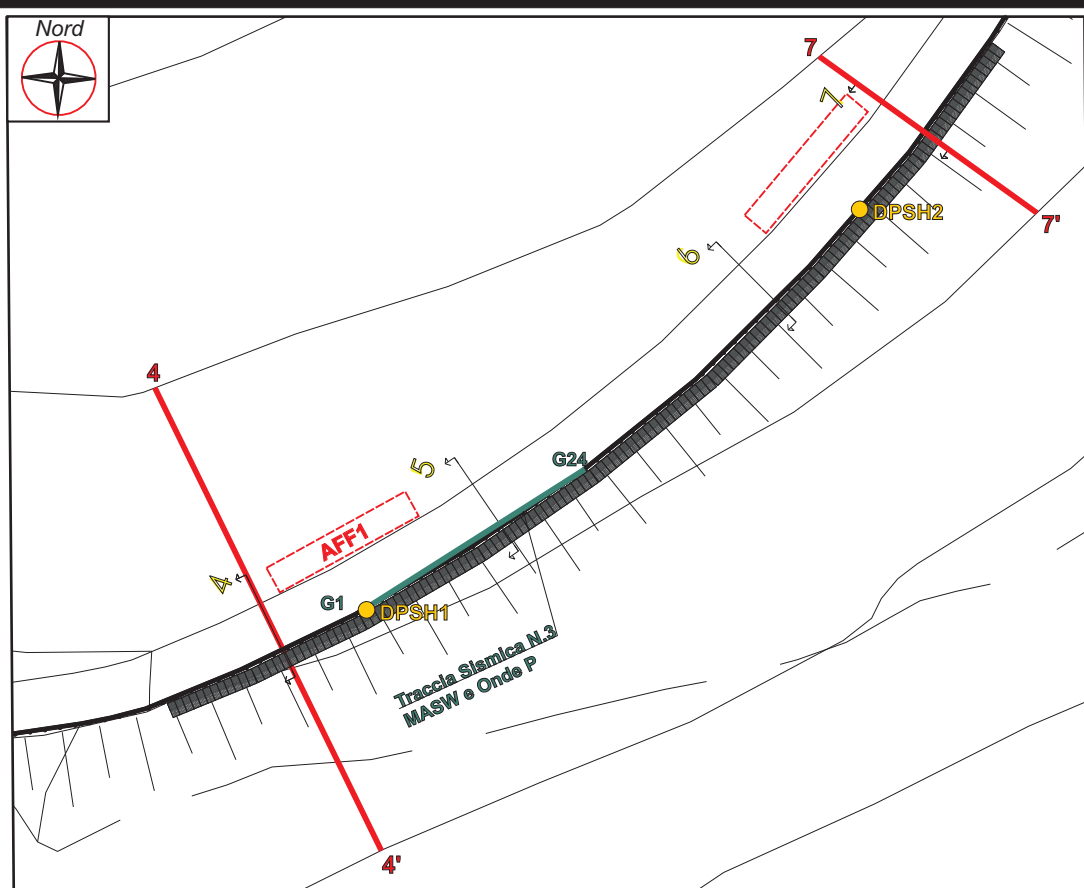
Planimetria del tracciato stradale compreso fra la Sez. 4-4' e Sez. 7-7', in scala 1: 1.000
